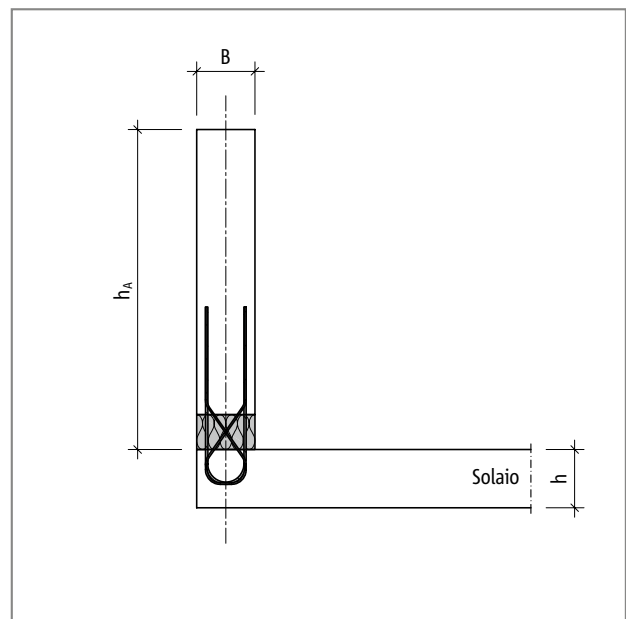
Schöck Isokorb® T tipo AP: schema statico con altezza del parapetto h_A
